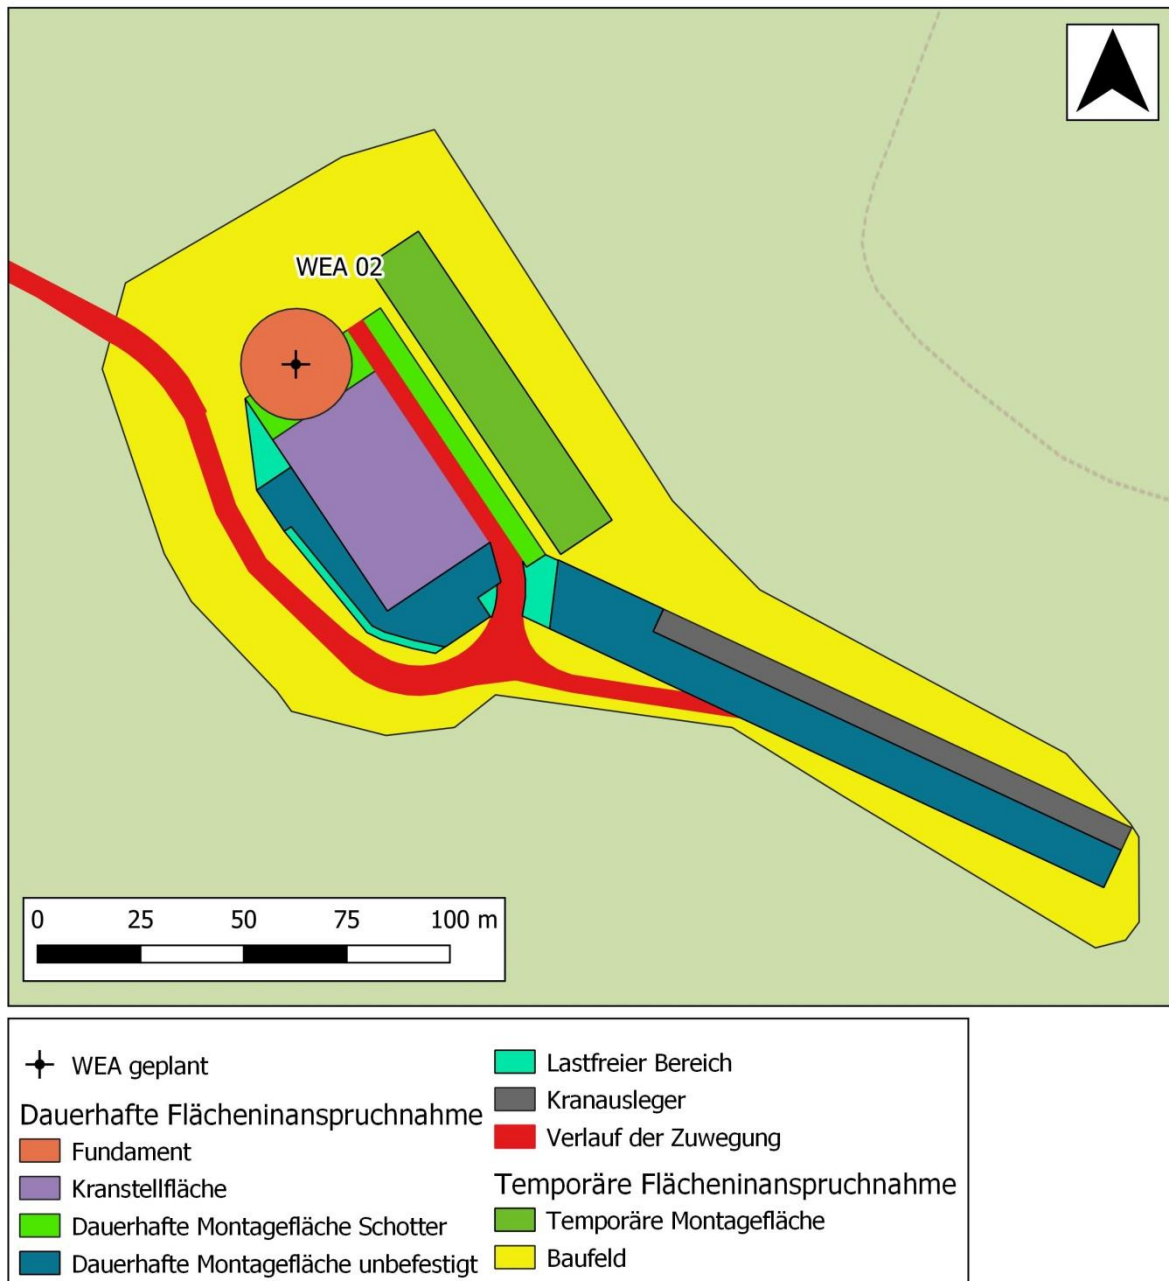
WEA-Standort 2 inklusive Baunebenflächen.²
